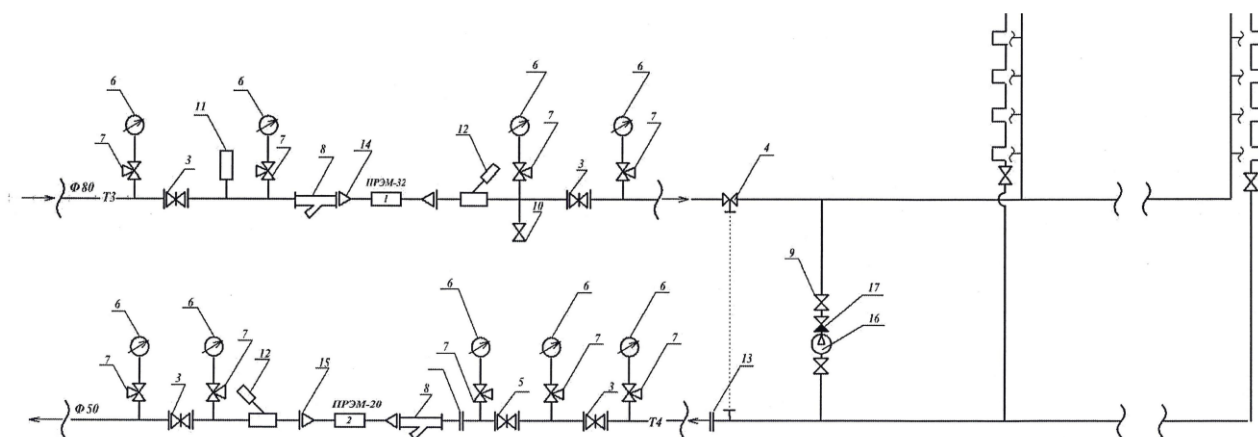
Схема теплового узла системы ГВС жилого дома:
